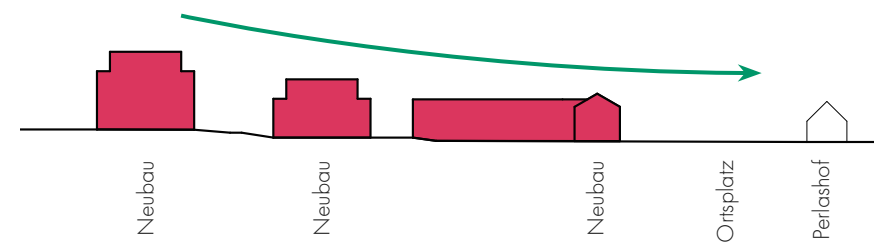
Schemaschnitt durch das Planungsgebiet: Gebäudehöhenanpassung
